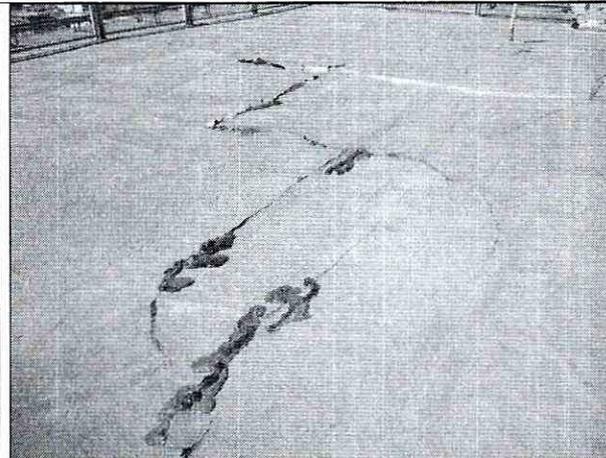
Afloramiento de brea asfáltica, daño en sistema de impermeabilización de la losa de terraza.
